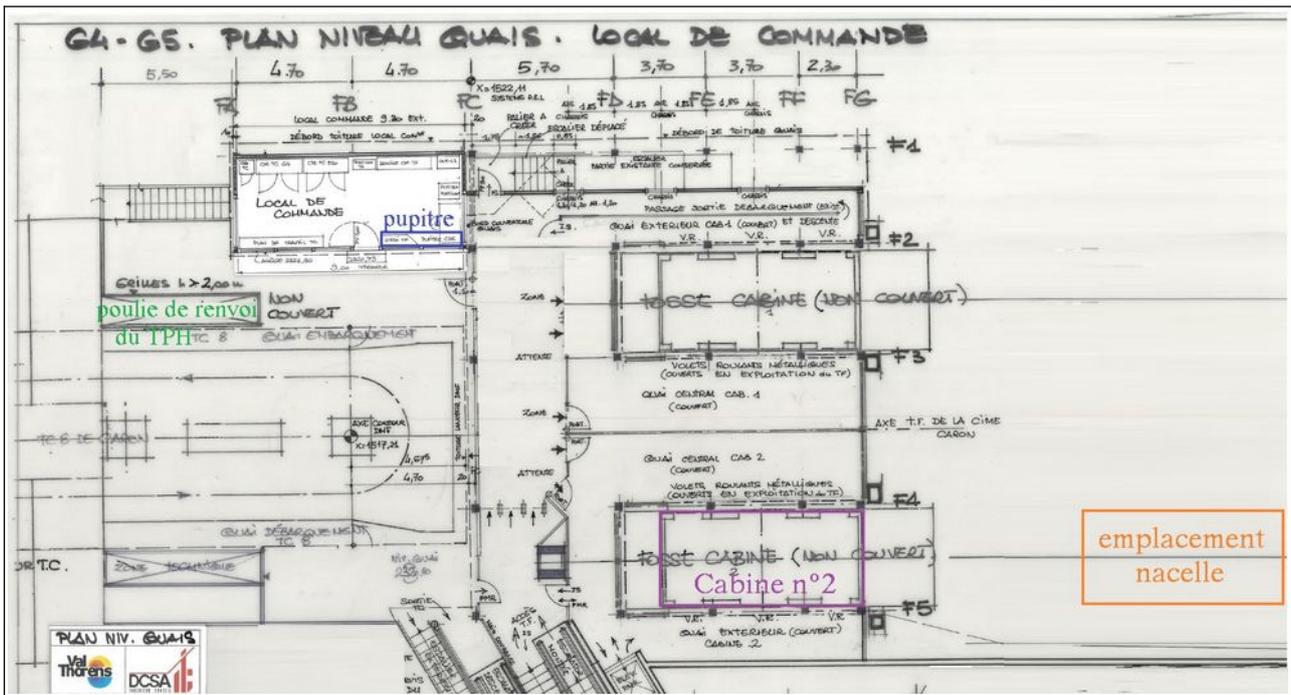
Plan détaillé de la gare inférieure et zones d'actions du conducteur le 19/11/24 (source DCSA modifiée)
